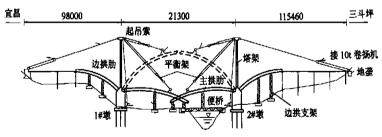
莲沱大桥竖转施工总体布置图(单位: mm)
